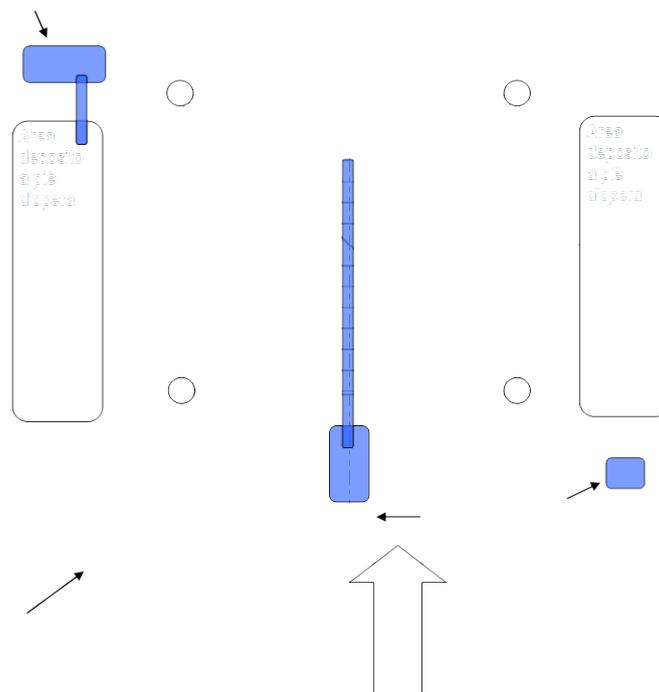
Planimetria dell'Area Sostegno (montaggio sostegno)
